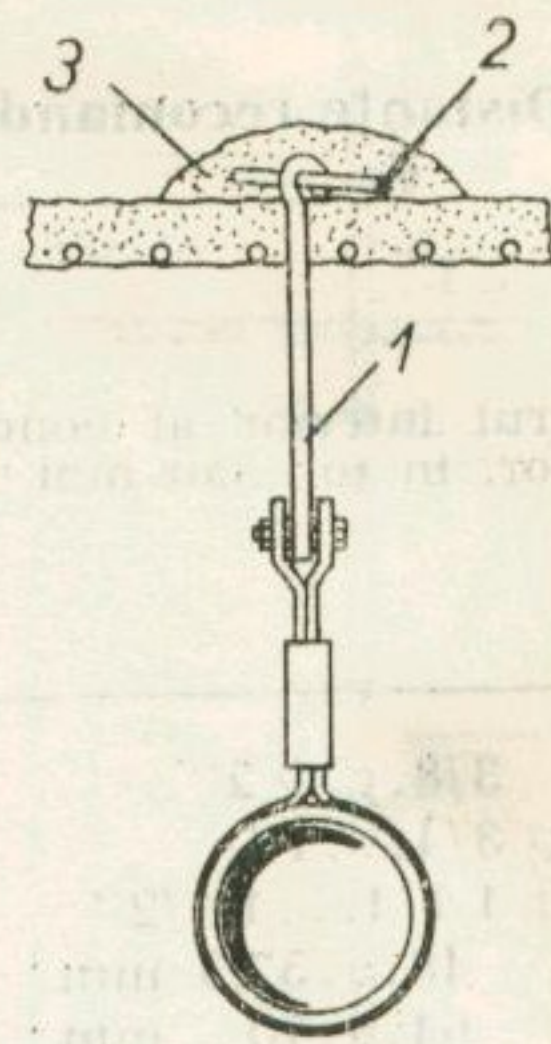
Prinderea suporturilor-ancoră în planșee :
